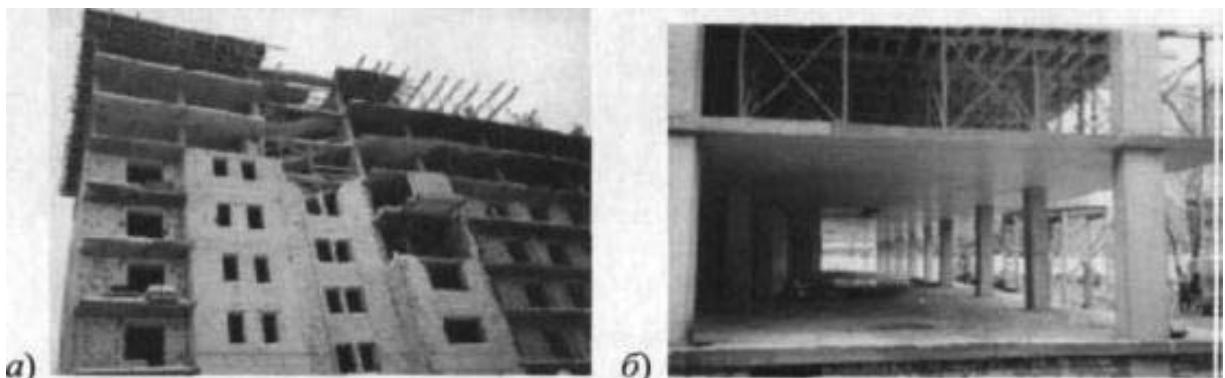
Многоэтажное жилое здание с железобетонным монолитным каркасом а– общий вид каркаса здания в стадии строительства; б– фрагмент монолитного каркаса
